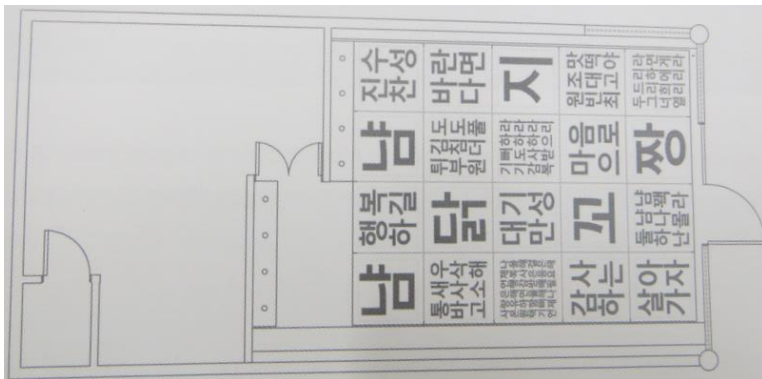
Planta de techo del restaurante con el revestimiento troquelado.
